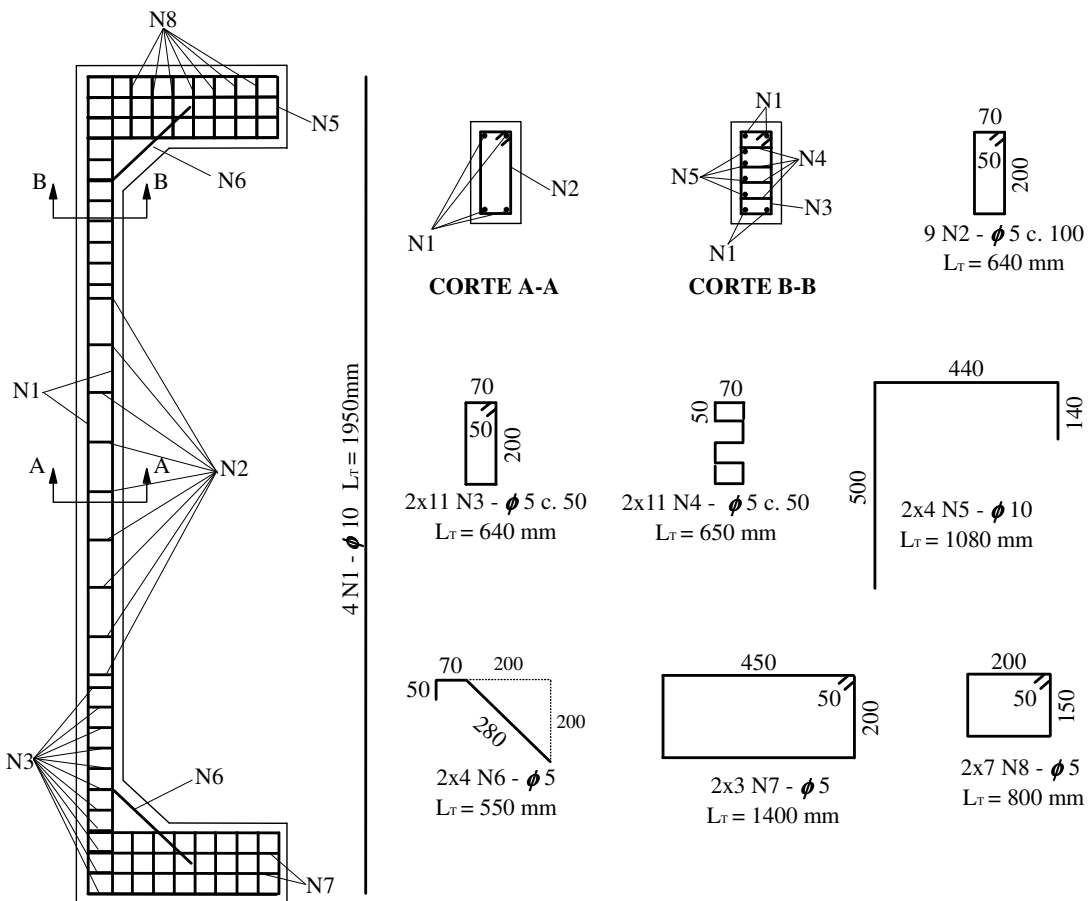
Detalhamento das armaduras dos pilares da Série PCA4 de ADORNO (2004)
